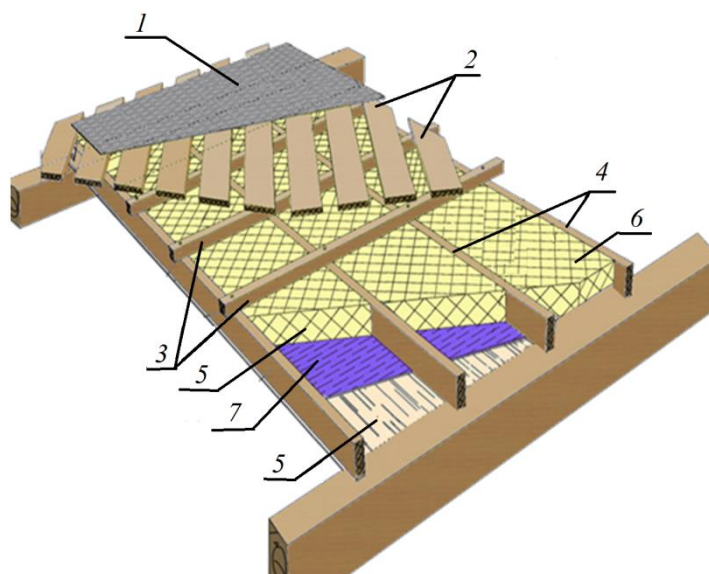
Дощатый двойной настил под рулонную кровлю: 1 – кровля, 2 - защитный настил из досок, уложенных под углом 45° к оси здания, 3 - рабочий разреженный настил из досок или брусков, 4 - прогон
